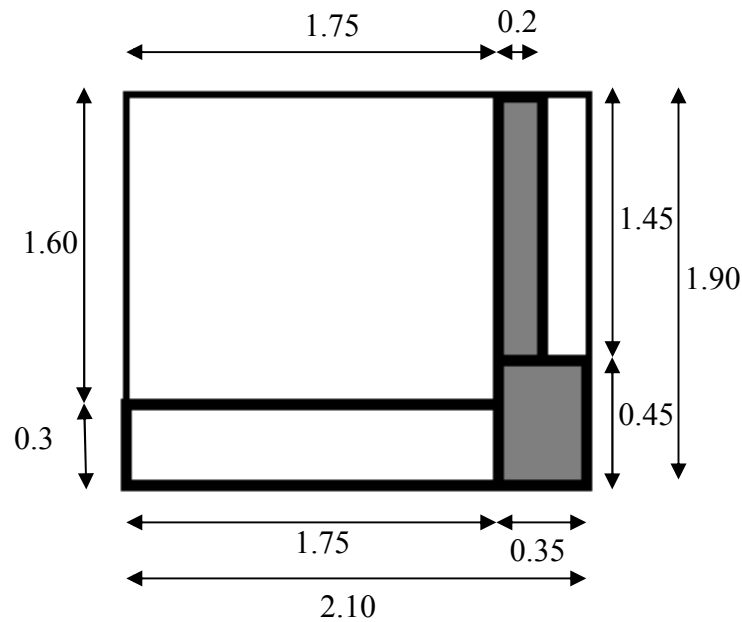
Les sections entourées par le poteau de la cage d'escalier à la terrasse.
